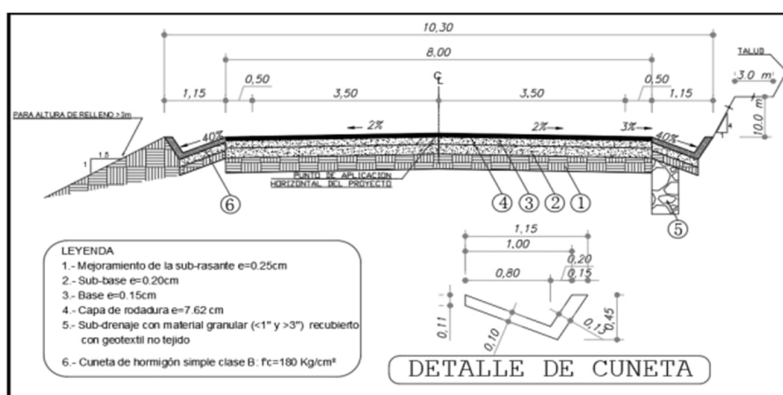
Sección típica de capa de rodadura concreto asfáltico tramo 2 y 3.
